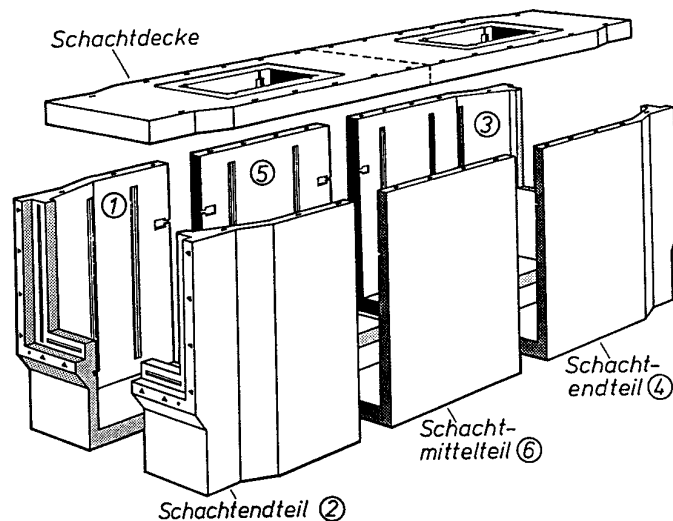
Stahlbetonfertigteilschacht KSch Typ II
